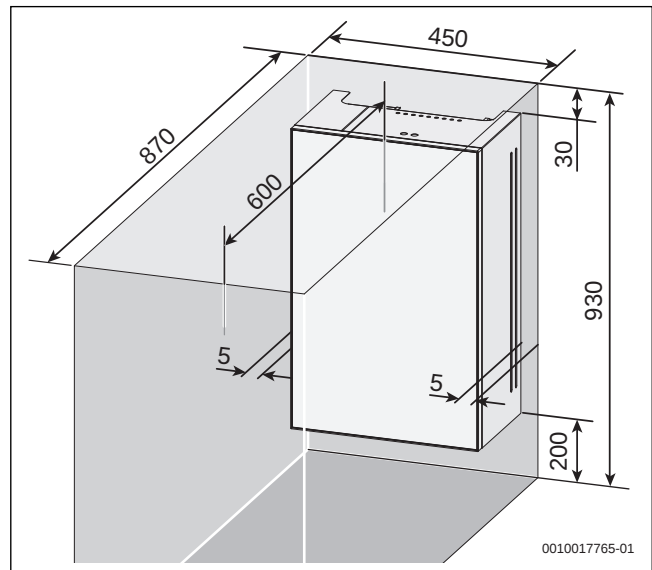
Mindestabstände für Montage und Wartung – Aufputzinstallation (Maße in mm)
